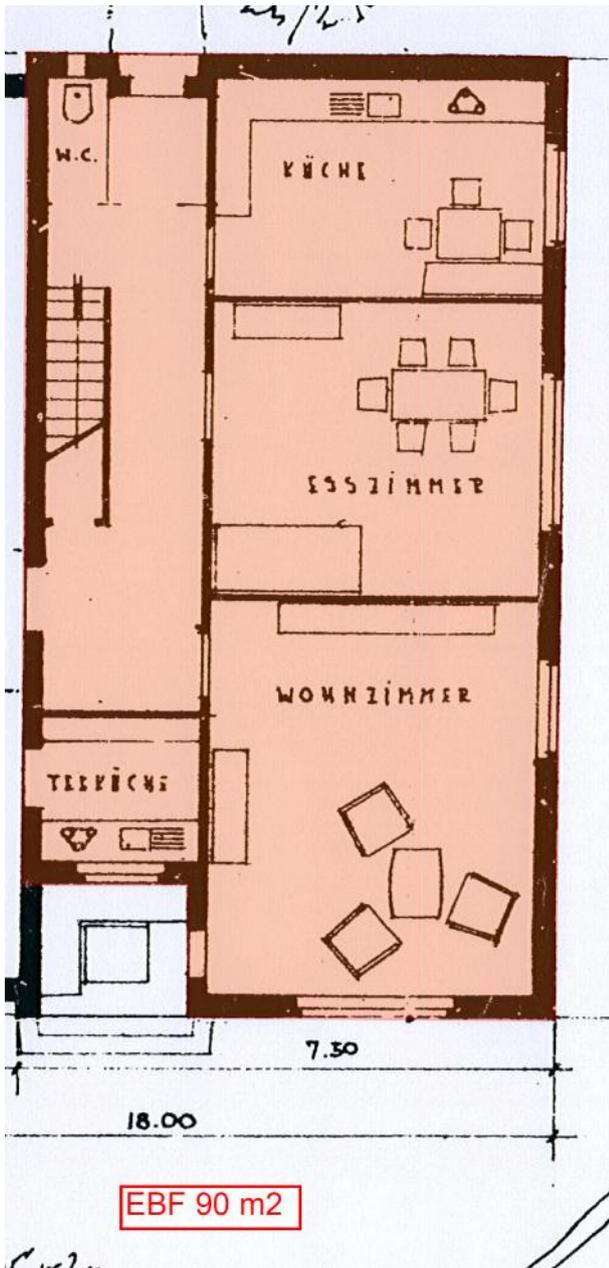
Grundriss EG, nicht massstäblich
